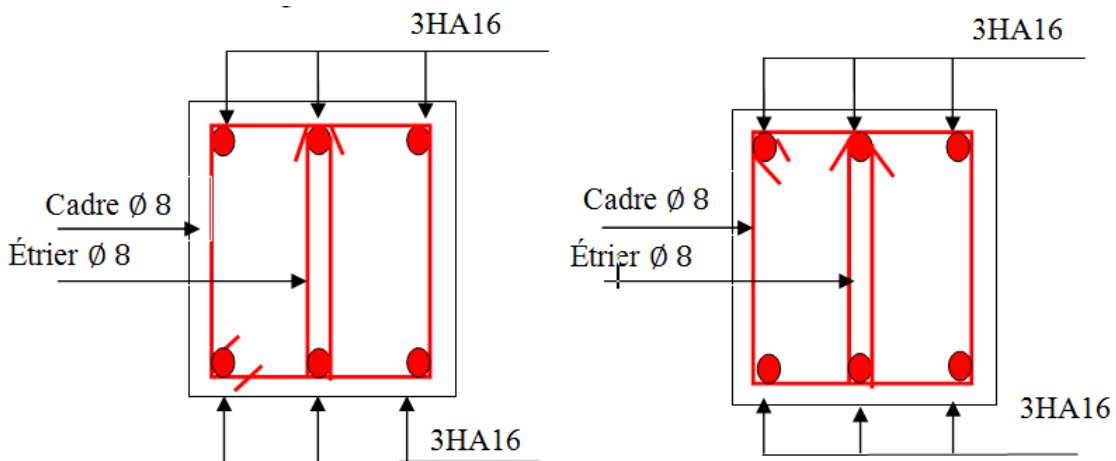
Schéma de ferrailage de la poutre principale du plancher RDC
